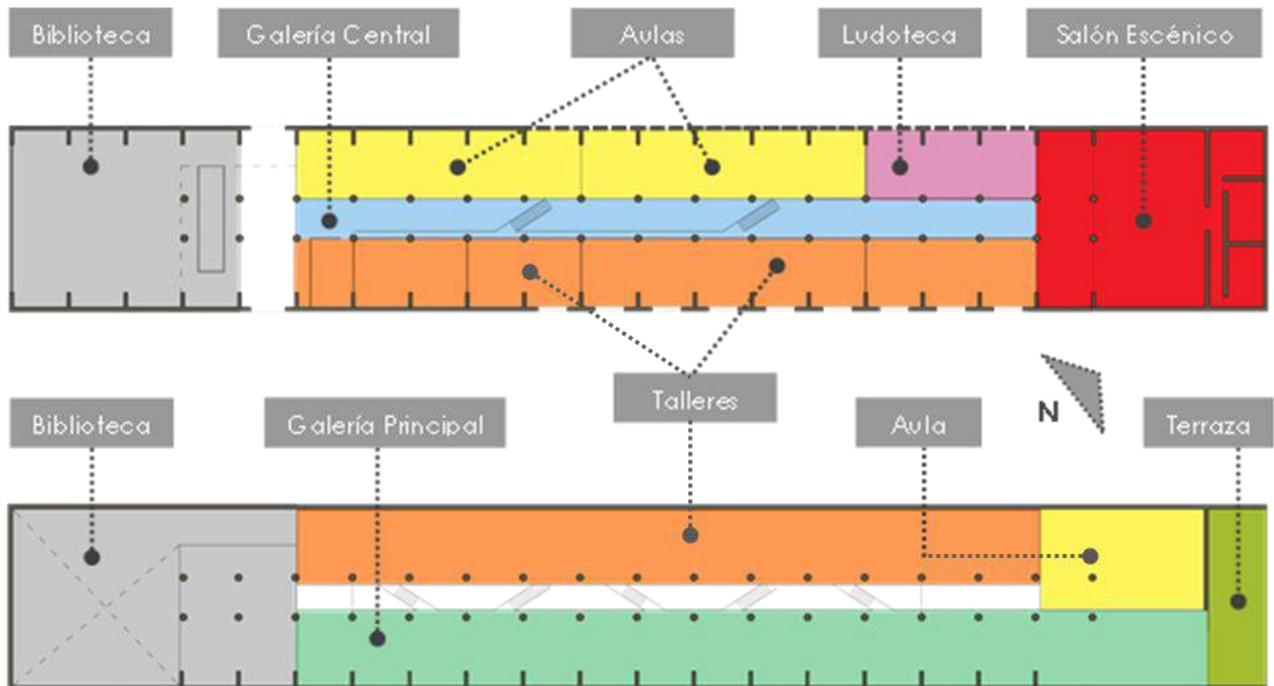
y 109. Esquema de zonificación de Planta Baja y Primer Nivel
